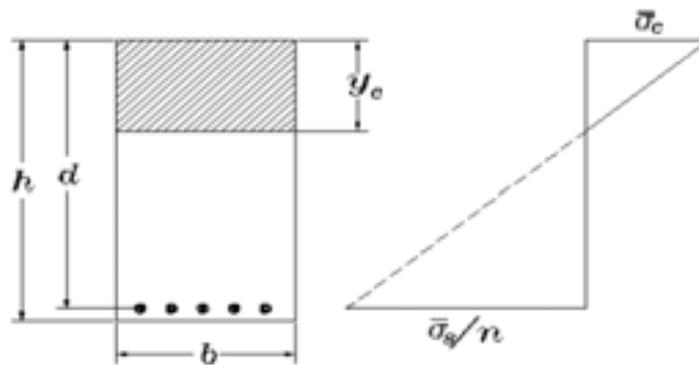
Tensioni indotte in una sezione in c.a. semplicemente inflessa
